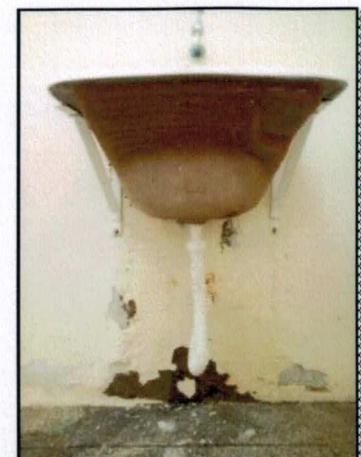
Foto da Parede: Foto aproximada da infiltração – LAVANDERIA
